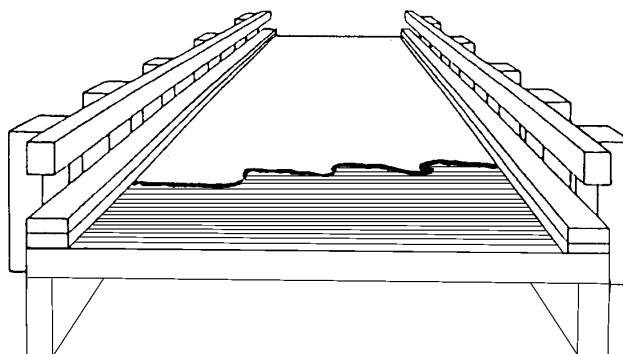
Tabuleiro transversal com protensão longitudinal
